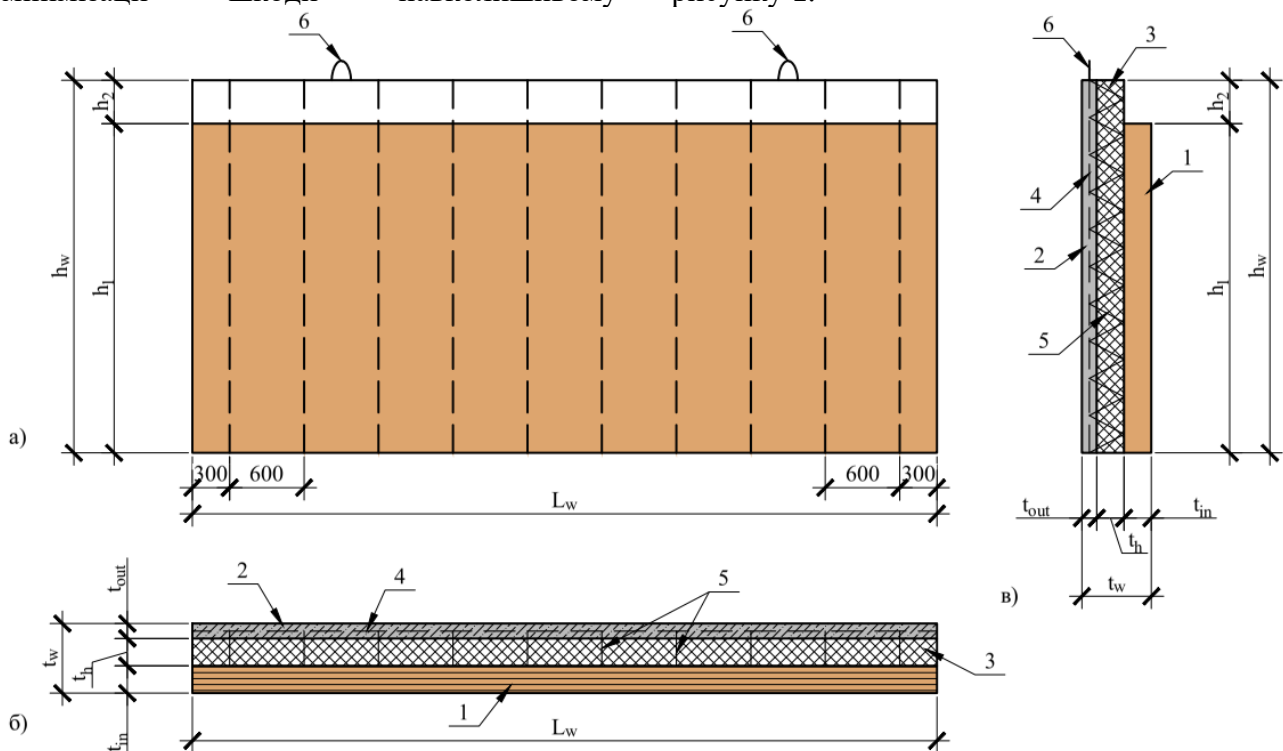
Конструктивне рішення гібридної деревозалізобетонної стінової панелі: а – вид спереду; б – вид зверху; в – вид збоку; 1 – внутрішній шар з перехресно-клеєної деревини; 2 – зовнішній шар із залізобетону; 3 – теплоізоляційне заповнення; 4 – арматурна сітка; 5 – гнучкі зв'язки; 6 – монтажні петлі
